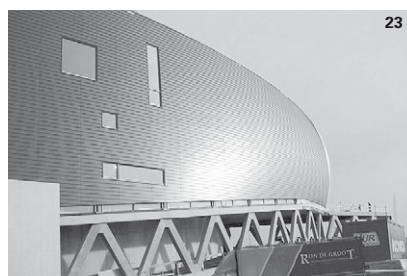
, 23, 33 : Théâtre LUXOR, Rotterdam, Hollande, CETRIS® FINISH, revêtement de façade, système PLANK
